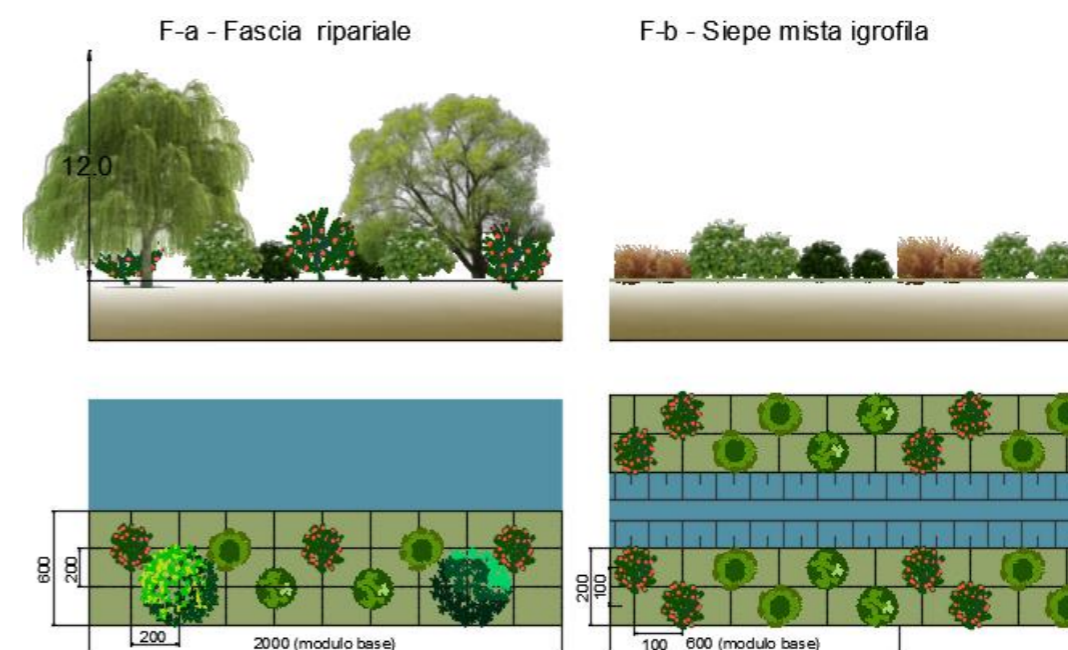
Modulo F – Sistemazione vegetale spondale
